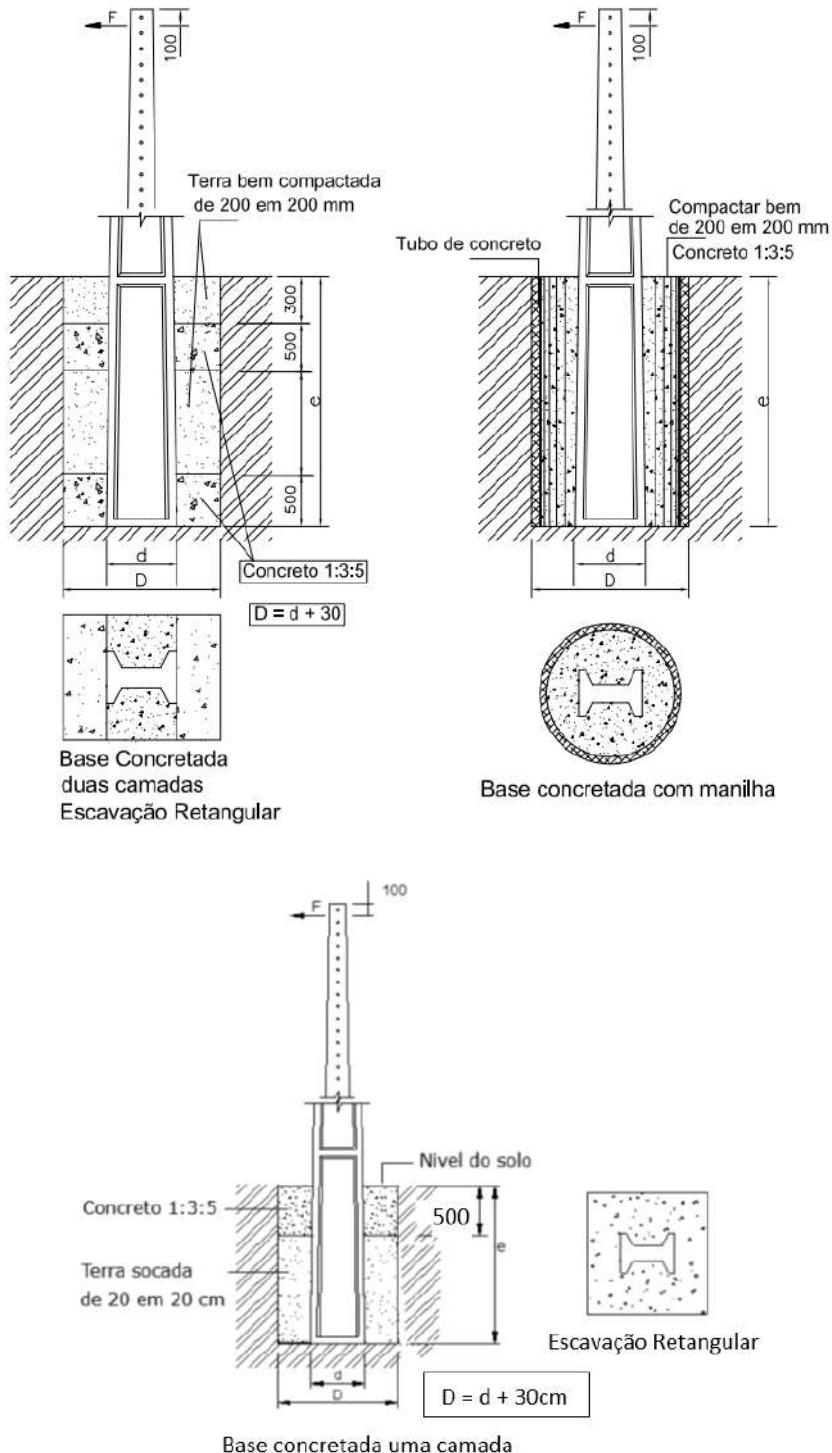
Engastamento de poste – Detalhes da fundação – Base concreto e base manilha
